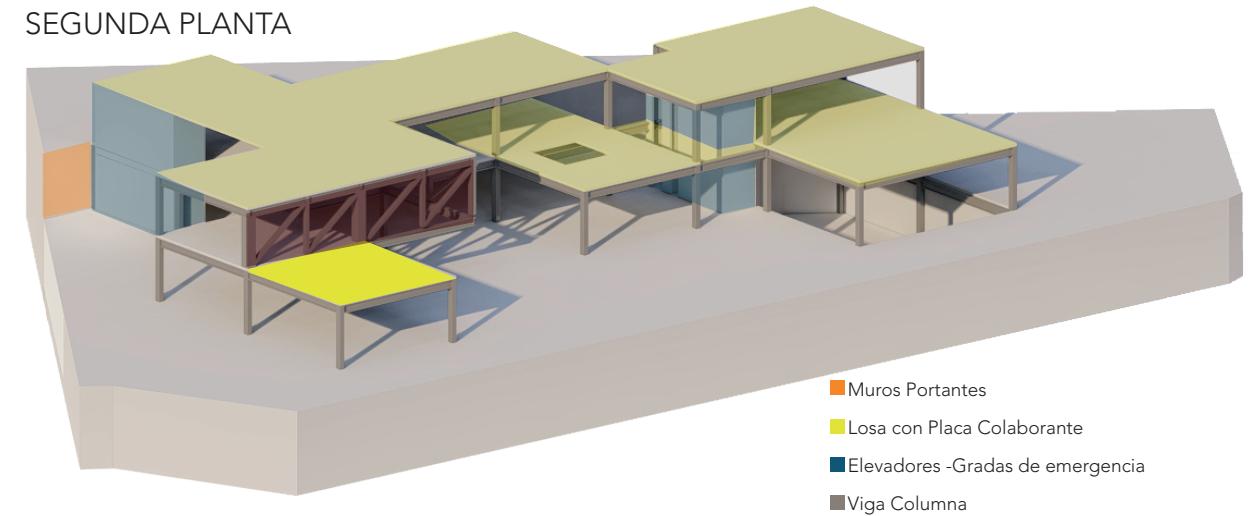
Isometrías de proyecto con elementos constructivos Fuente: Autor
